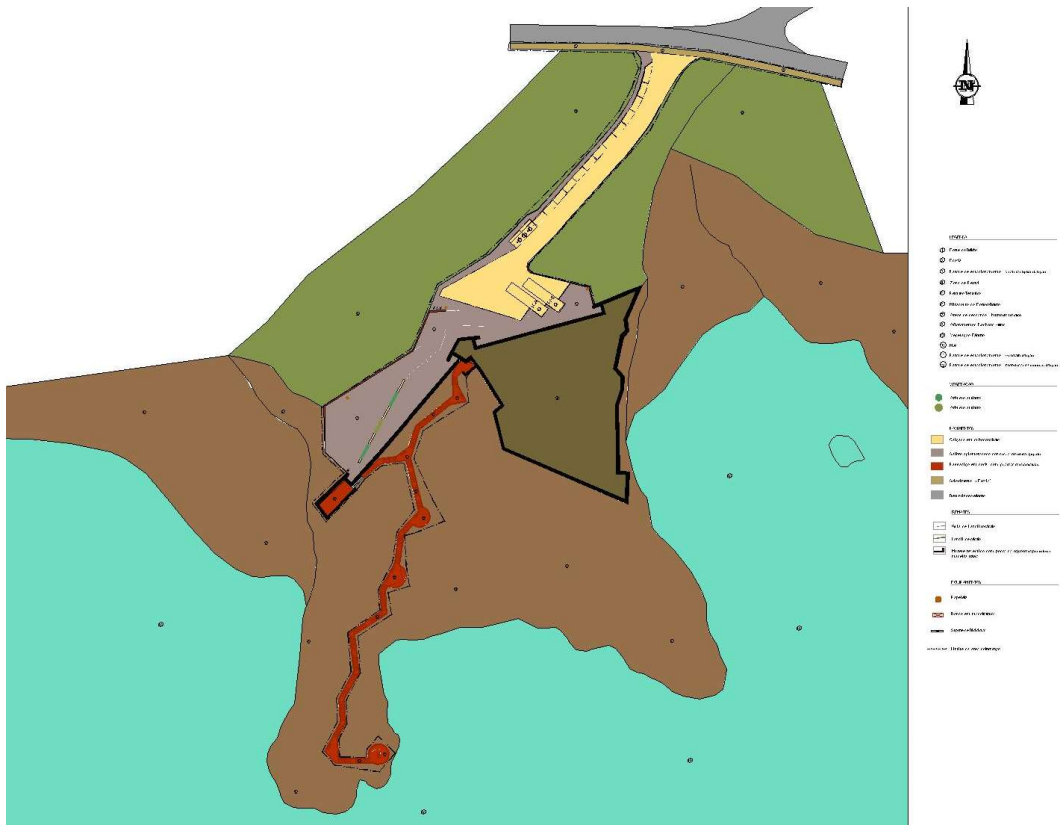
Planta geral do arranjo dos espaços exteriores.
